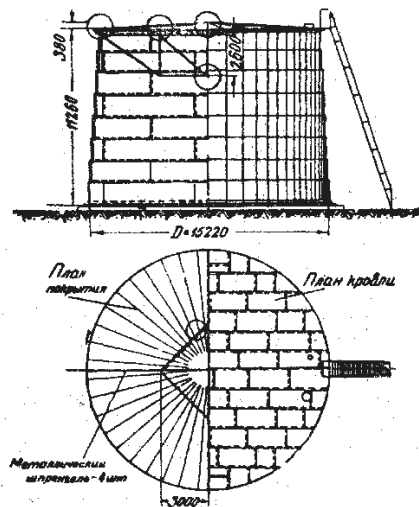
Резервуар сварной по ГОСТ 2486-44
